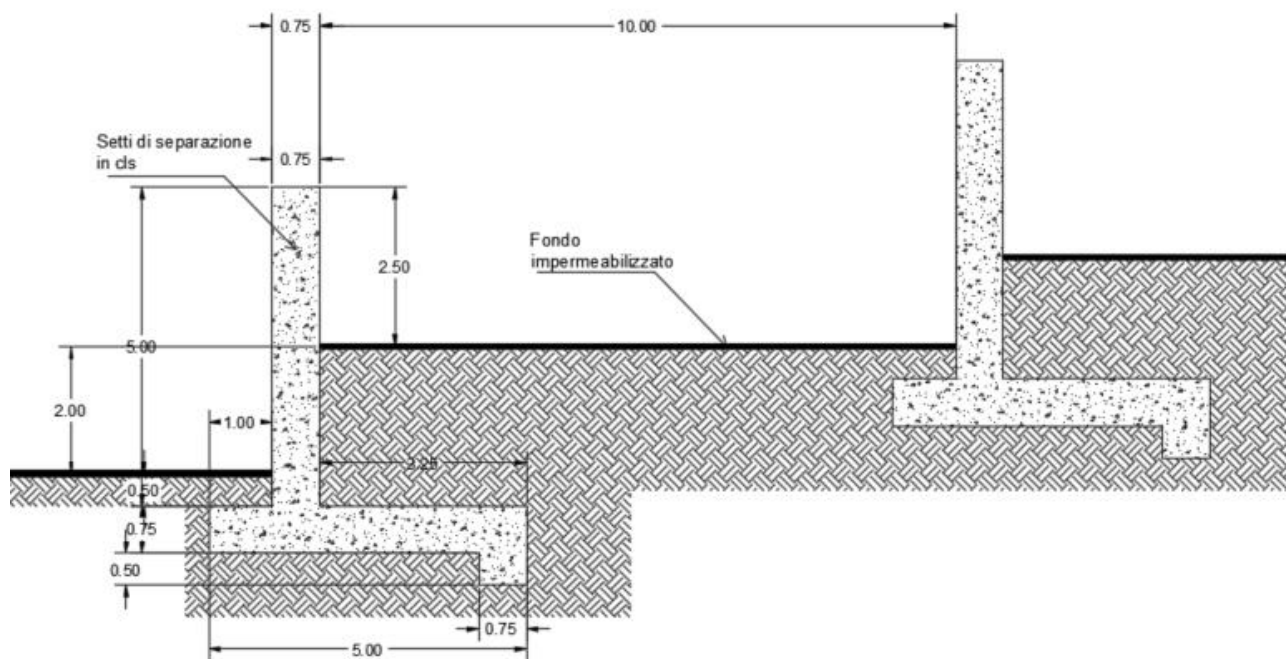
SEZIONE TIPO DEI SETTI IN CALCESTRUZZO ARMATO
